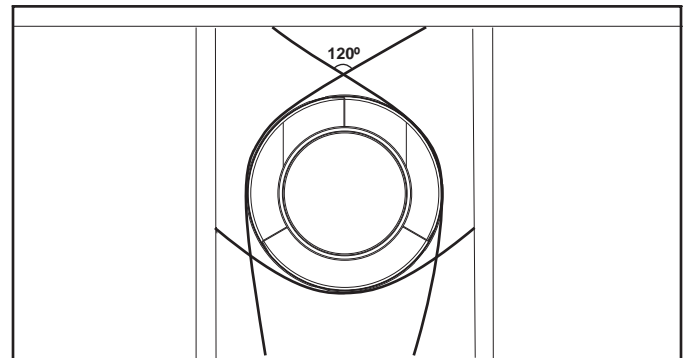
Sujeción de las secciones verticales del tubo de escape
